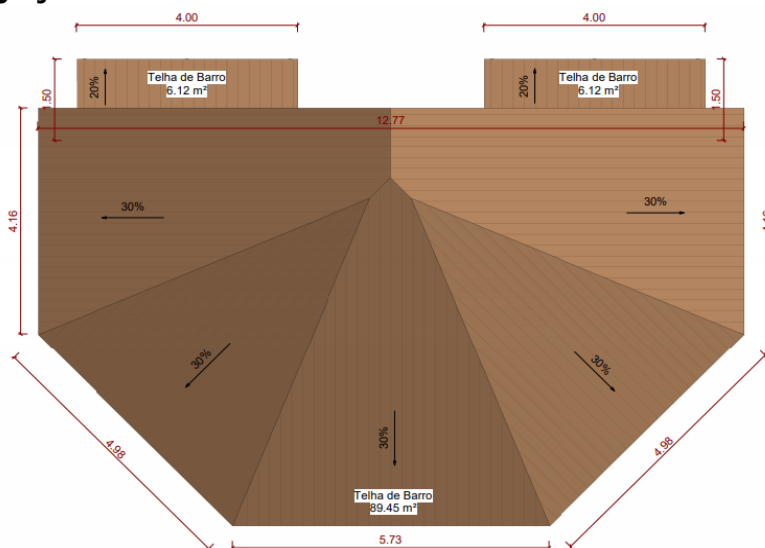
Imagem - Prancha 02/02 – Projeto Executivo – Arquitetônico-Telhado
